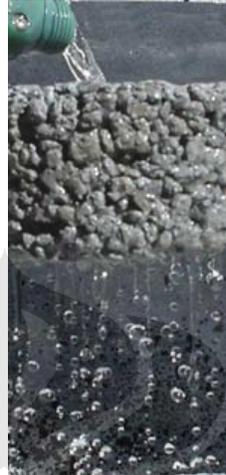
Potongan Melintang *Permeable Pavement
